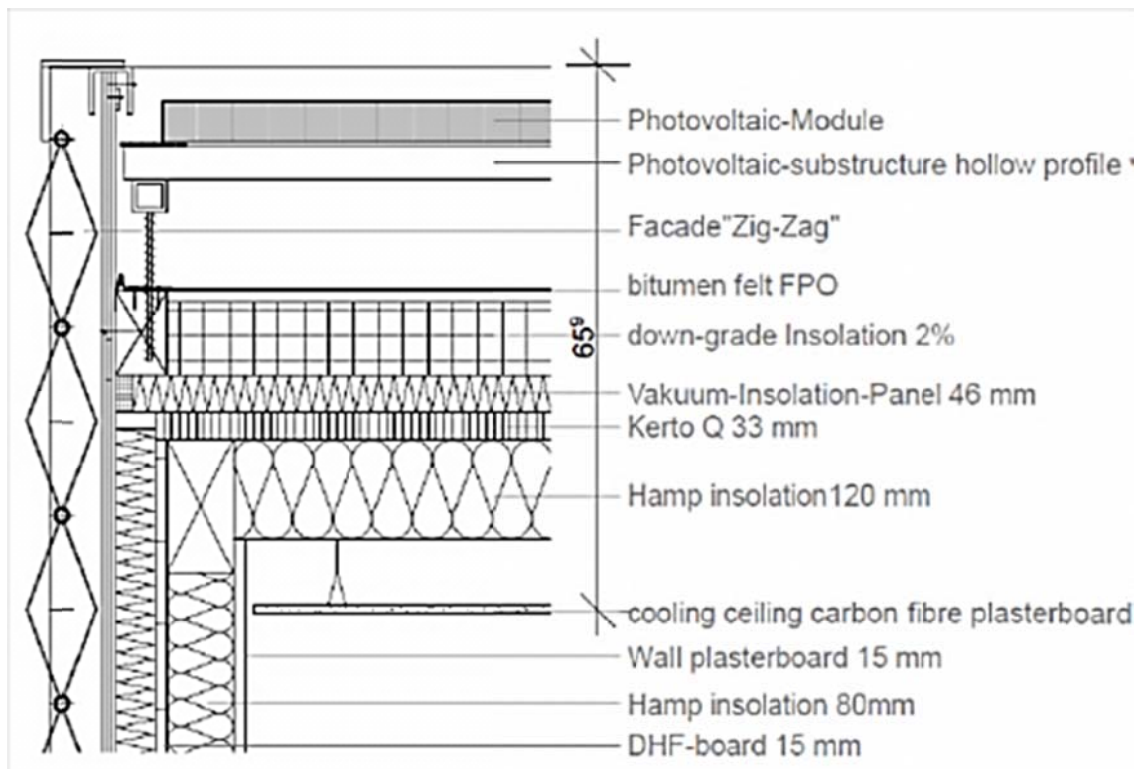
Sección encuentro fachada con cubierta. Fuente: ROS_CD_2010-09-21
